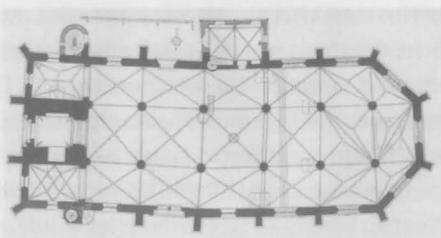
Grundriss der Pfarrkirche St. Johannes in Neumarkt. 1404 wurde Pfalzgraf Johann Statthalter der Oberen Pfalz. Er ließ an das fertige Langhaus einen dreischiffigen Chor nach Heidelberger Vorbild bauen. Diese Planänderung war nur mit einer nach Norden verschwenkten Achse zu realisieren (Hofmann, Mader: Kunstdenkmäler, wie Anm. 84, S. 13).
